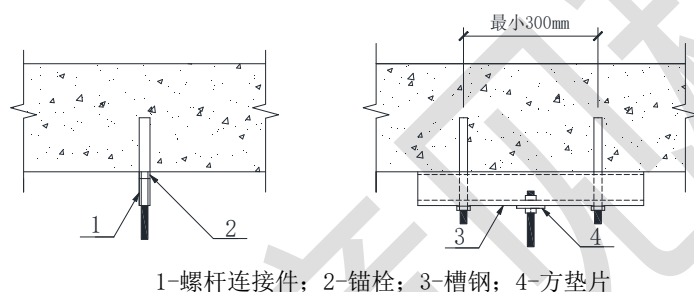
吊杆根部构造示意图（钢筋混凝土结构）
